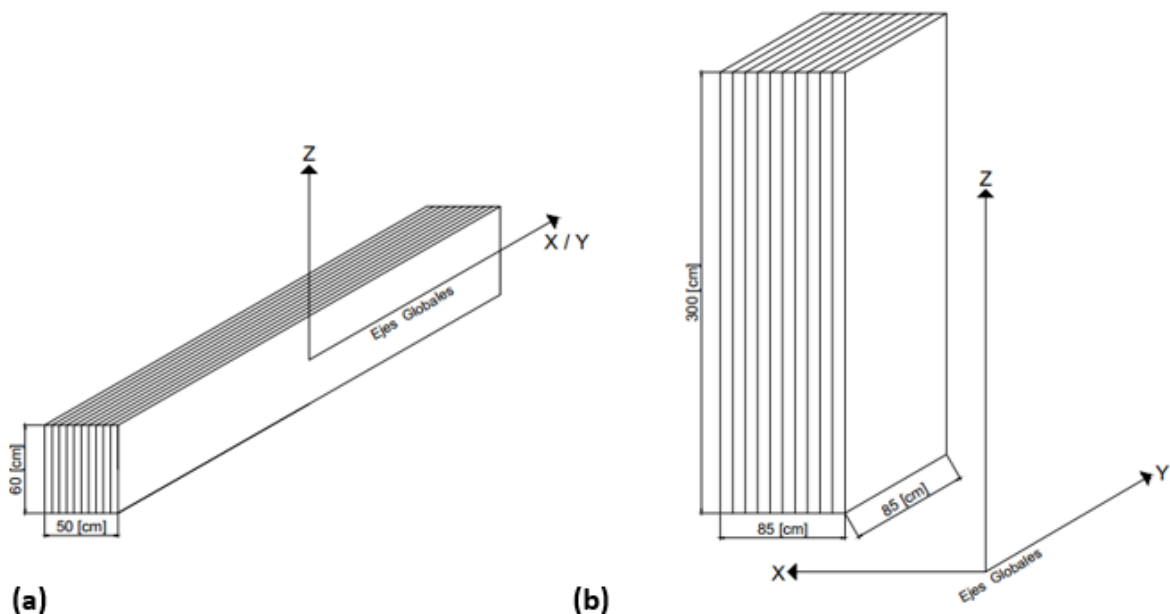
Detalle: (a) vigas de LVL; y (b) columnas de LVL.
